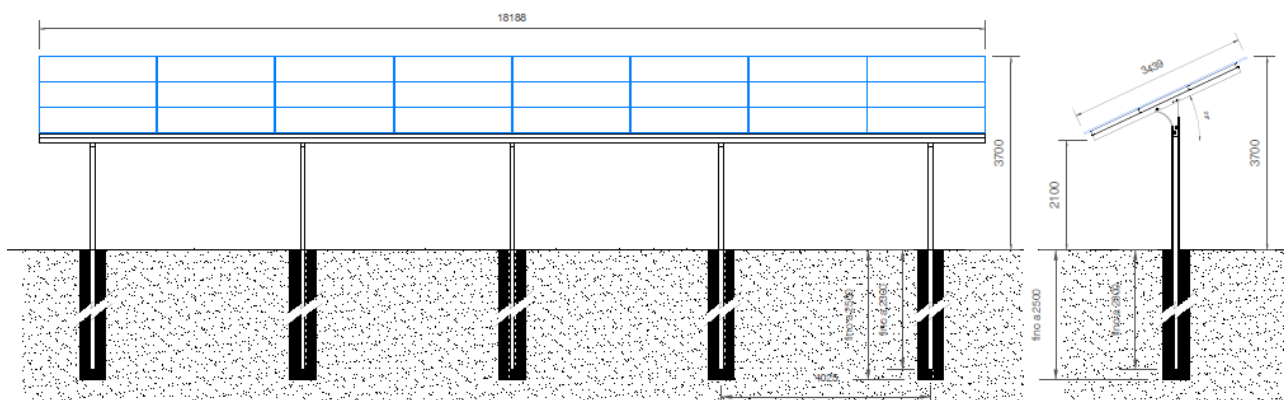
Strutture di sostegno fisse: vista frontale (quote in mm)
